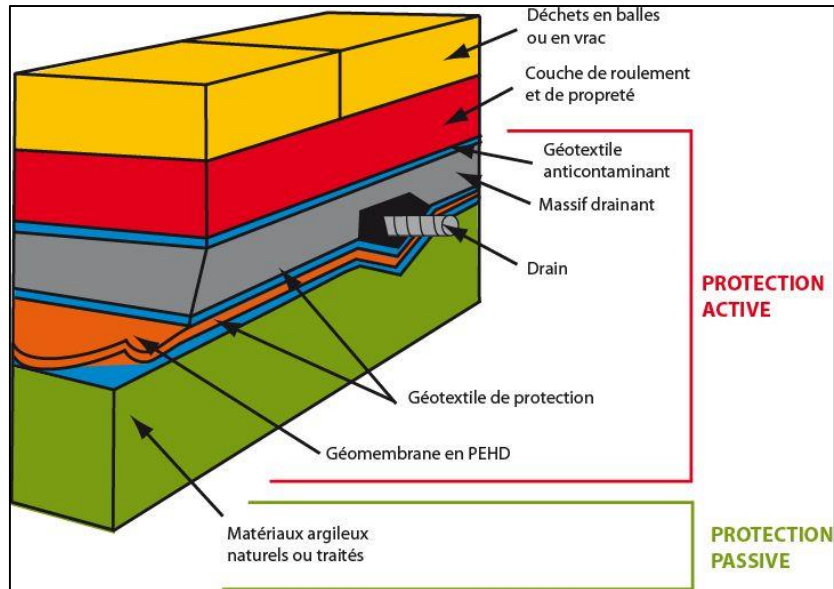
Plan de coupe affichant les couches de protection dans un casier de stockage de déchets
